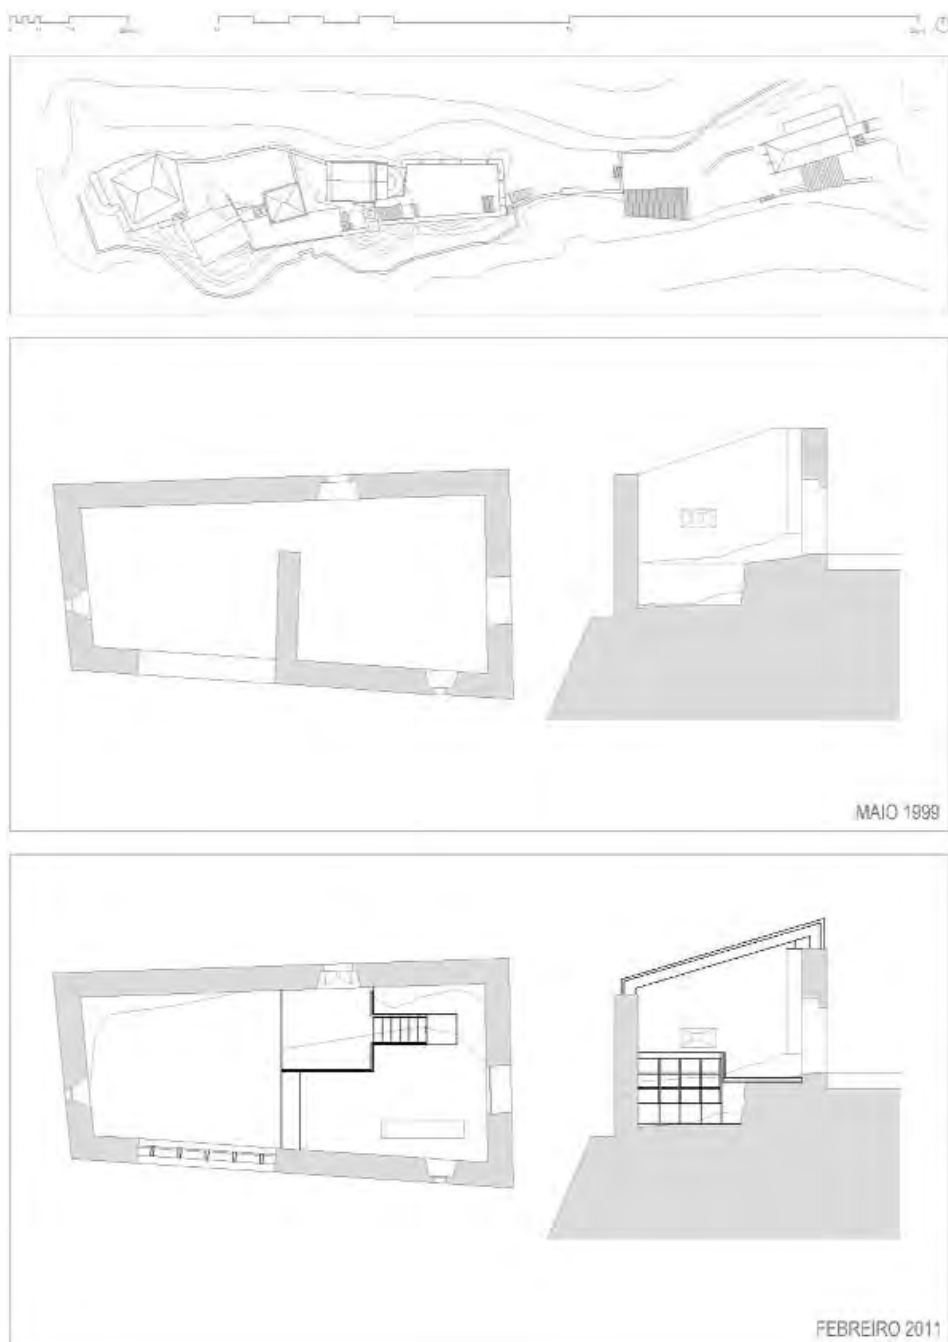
CAAVEIRO. Planta e sección transversal do Pavillón de información.
